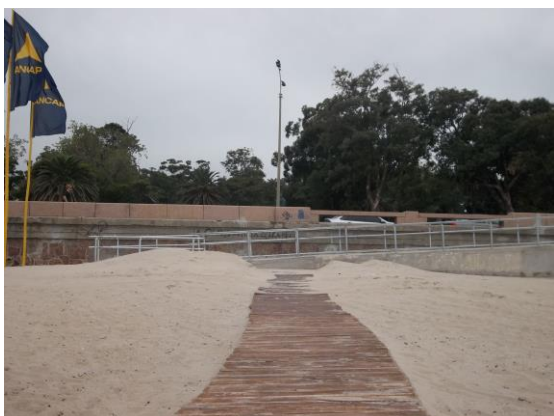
Vista longitudinal de la rampa de acceso en Playa Verde.
